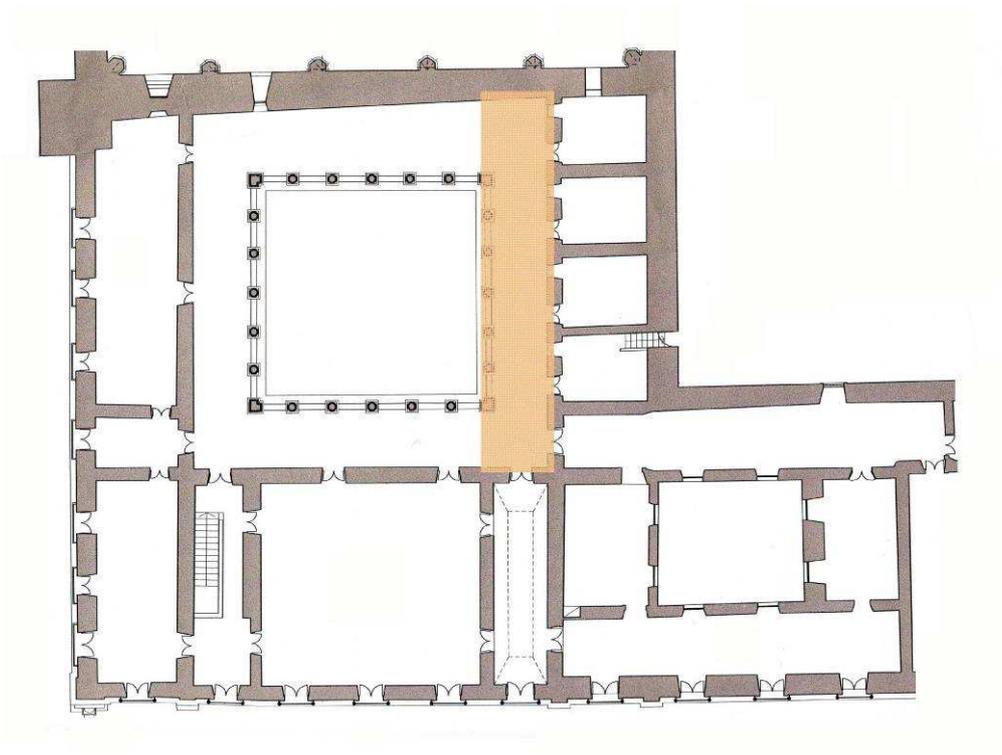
Localização da galeria Sul na planta do piso superior do levantamento de 2003.
